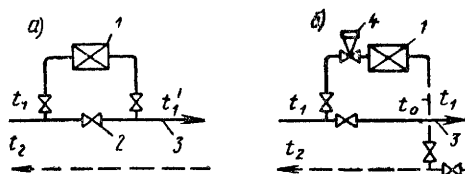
Схемы присоединения воздушонагревателя к теплопроводам
